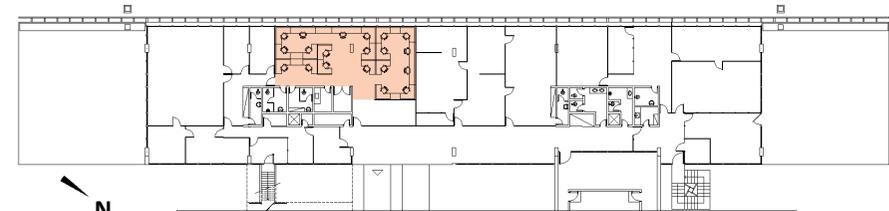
Planta Baixa do 2º Pavimento da Reitoria (Bloco B)
